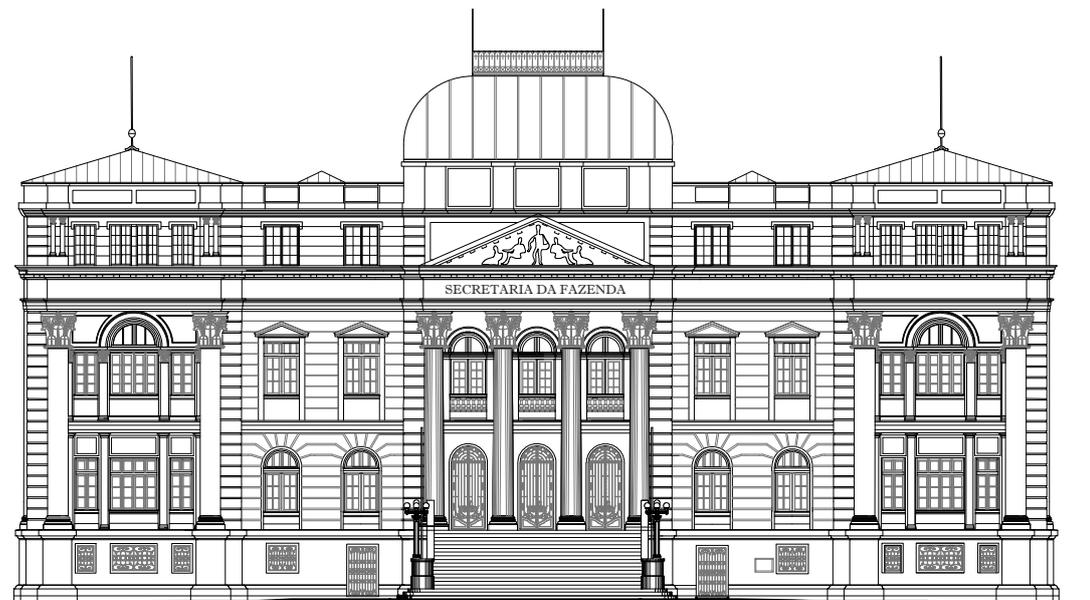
Redesenho da fachada principal da Secretaria da Fazenda com o acréscimo de um pavimento. Projeto de Barros.
